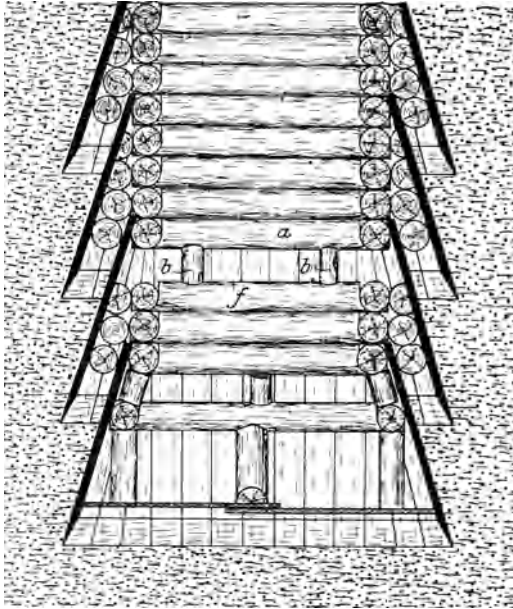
Einbau des Schlußgeviertes in einem Getriebefeld.
